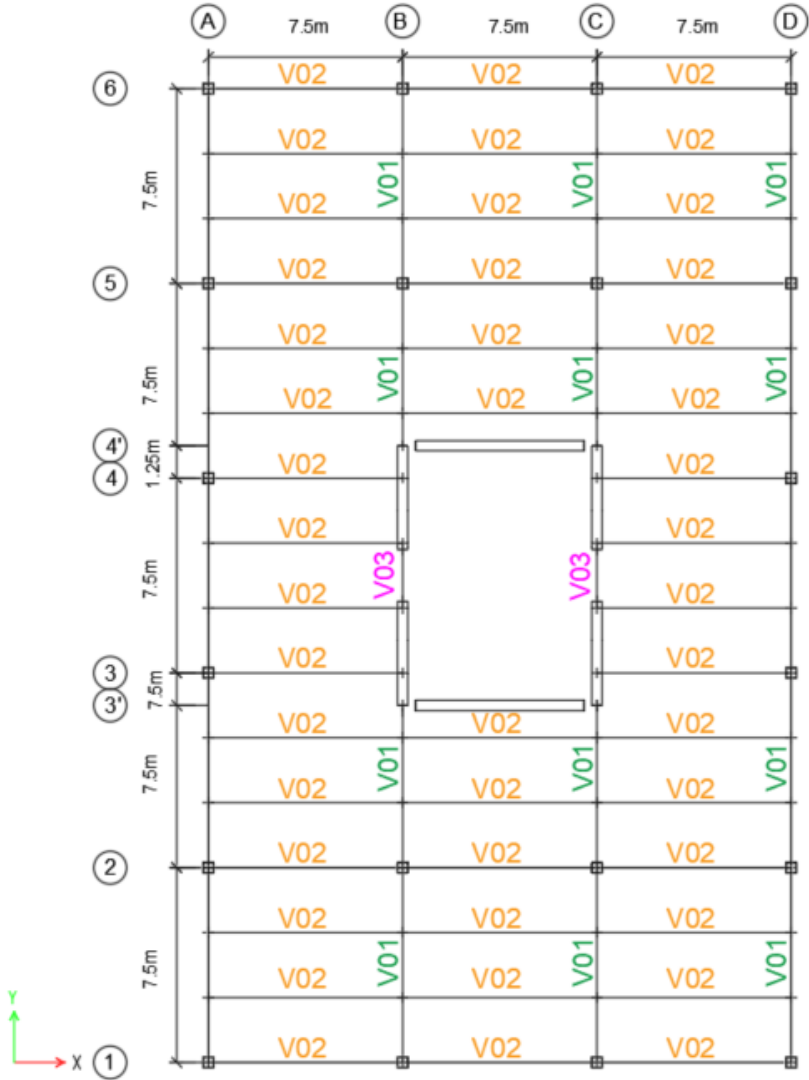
Planta Tipo Arquetipos 8, 12 y 16 pisos.
